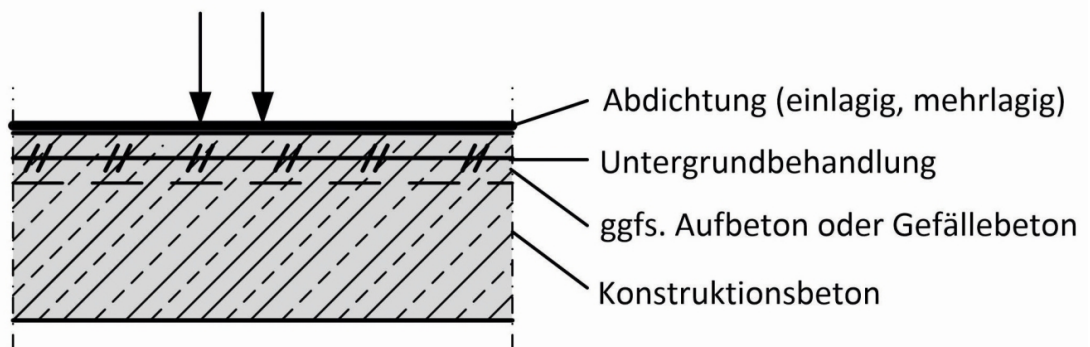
Nicht belüftetes befahrbares Dach (Parkdach Pkw) (Quelle: Schmidt)
